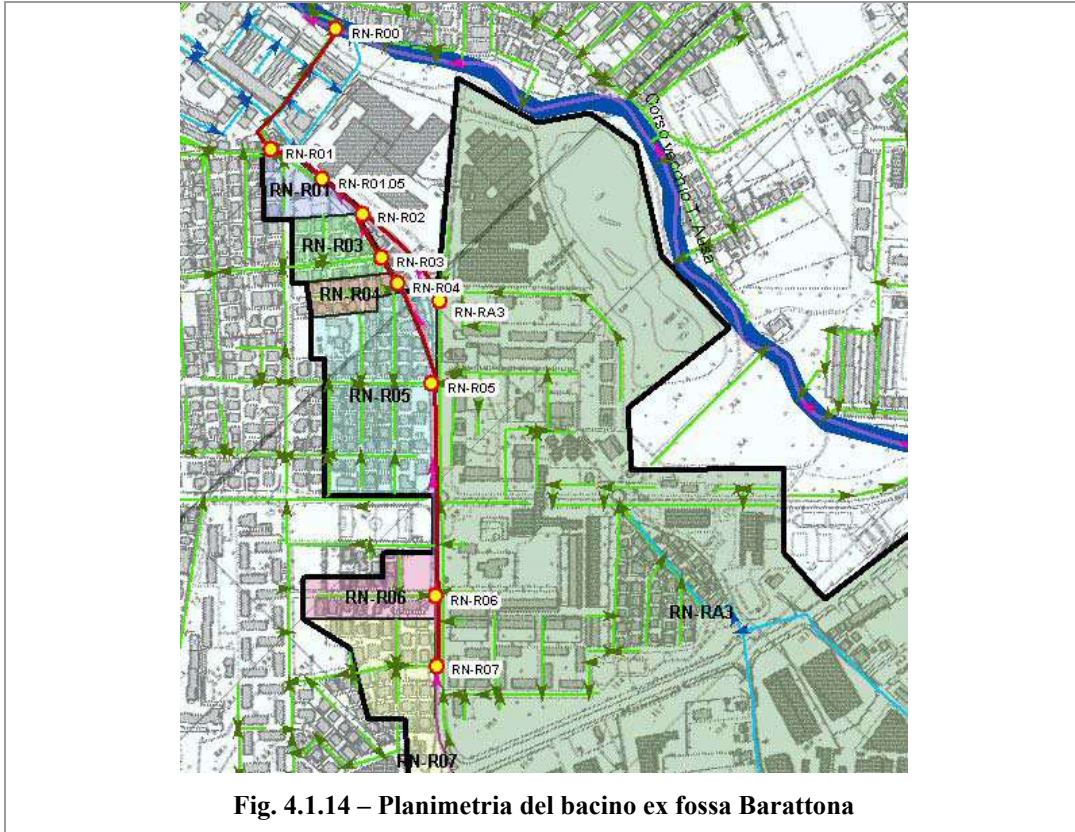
Planimetria del bacino ex fossa Barattona
